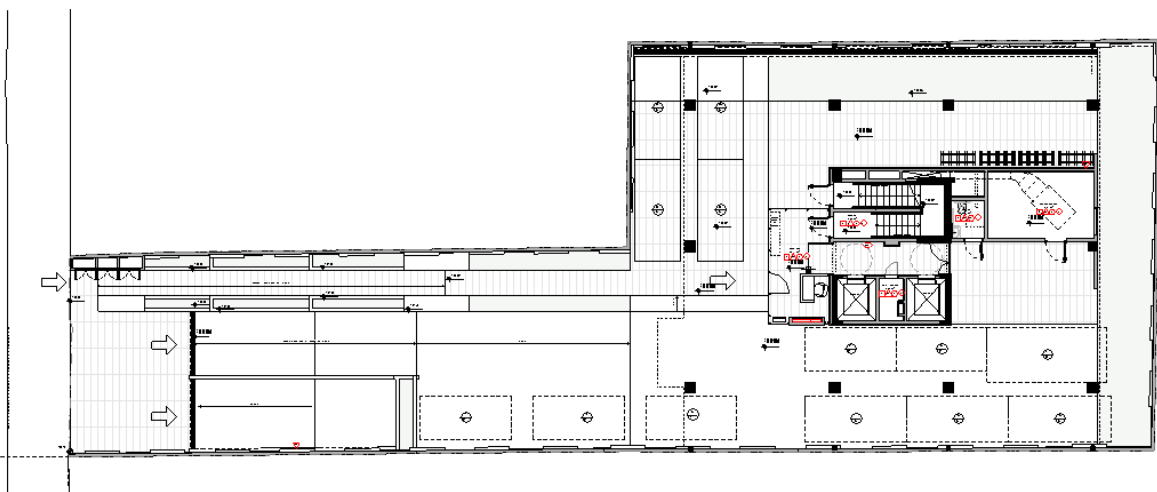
Planta Baixa 1º Pavimento Subsolo
